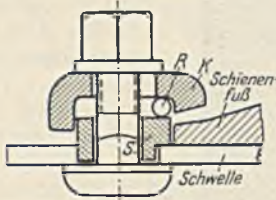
Durch Einlegen eines Rundeisens *R* zwischen Spurplättchen *S* und Klemmplatte *K* wird das Einschieben des Schienenfußes erleichtert und beschleunigt.
